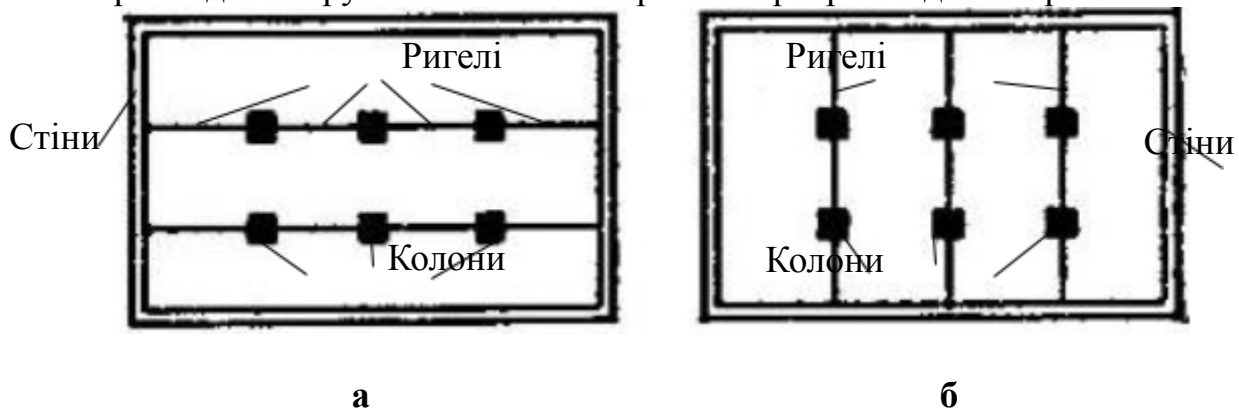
Варіанти компонування збірному каркасу: а – з поздовжнім напрямком ригелів; б – з поперечним напрямком ригелів.
